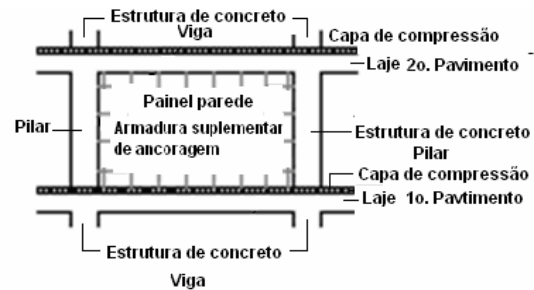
União de parede de painéis com laje, pilares e viga – vista frontal
